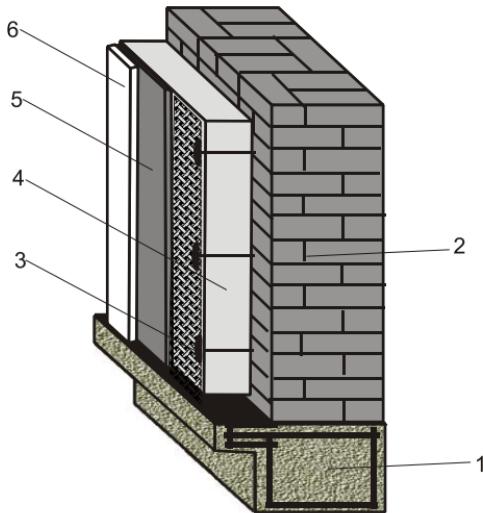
Фасад "мокрого типа": 1 — монолитно-армированный пояс с устройством упора; 2 — полнотелый керамический кирпич, также это может быть силикатный кирпич; 3 — дюбели для крепления фасадной теплоизоляции, расход 6—7 штук/м²; 4 — теплоизоляционный слой 100—120 мм, в качестве которого можно применить минераловатные плиты или плиты из вспененного полистирола; 5 — слой армирующей шпаклевки с армирующей сеткой; 6 — декоративная штукатурка, клинкерная плитка, облицовочный камень
